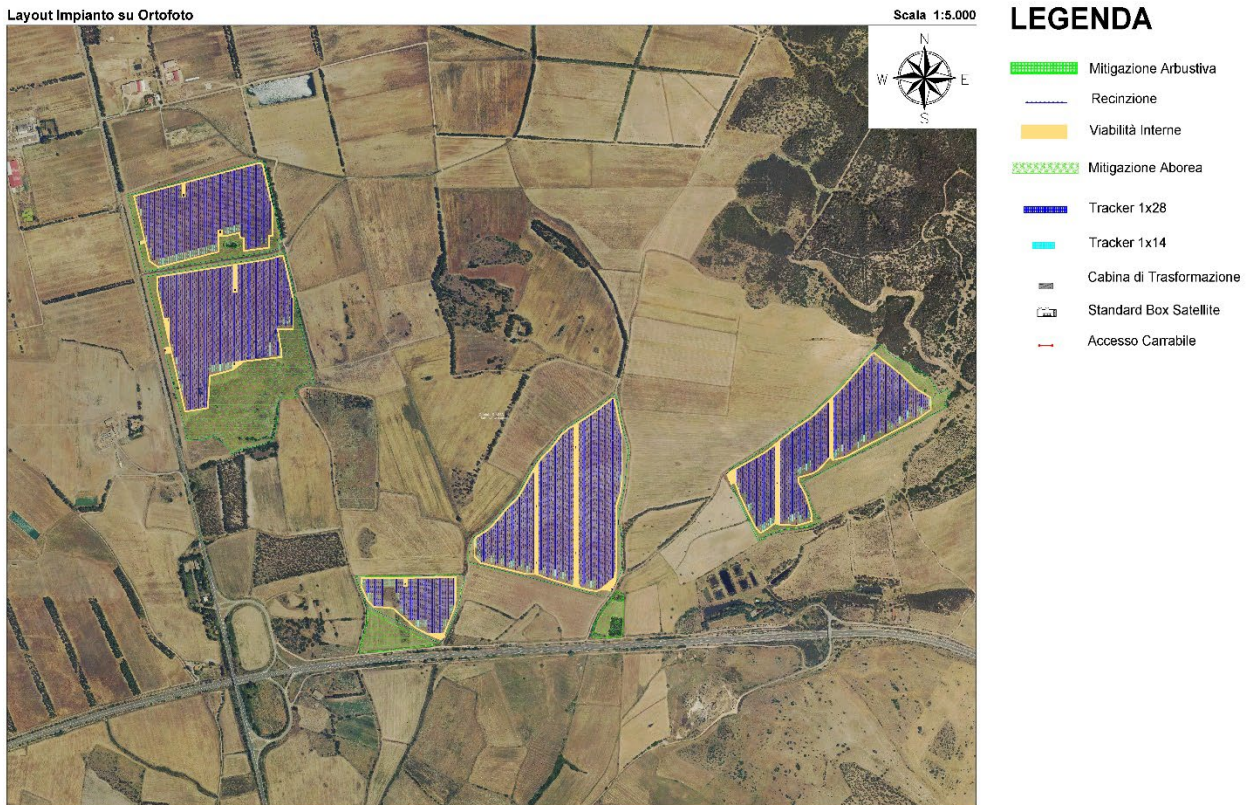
Layout del futuro impianto FV_SILQUA su Ortofoto
